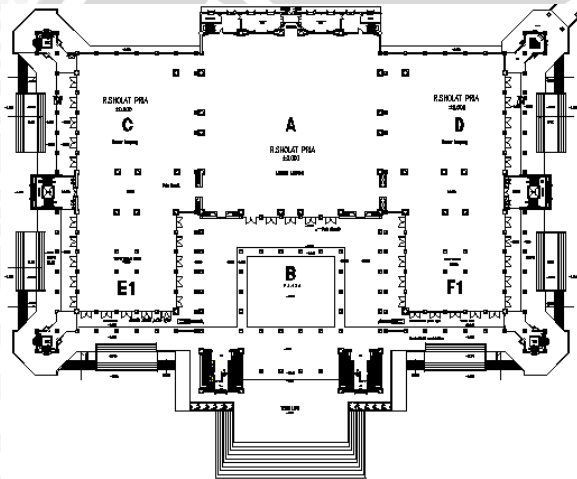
Perspektif denah ruang pada tiga lantai dalam bangunan MAS
